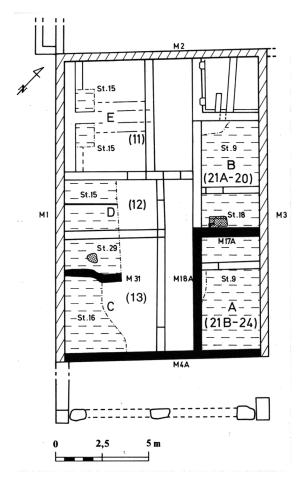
Plan schématique de l'état 2. En hachuré, murs-solins hypothétiques construits avant les murs en maçonnerie. Echelle 1: 200.
